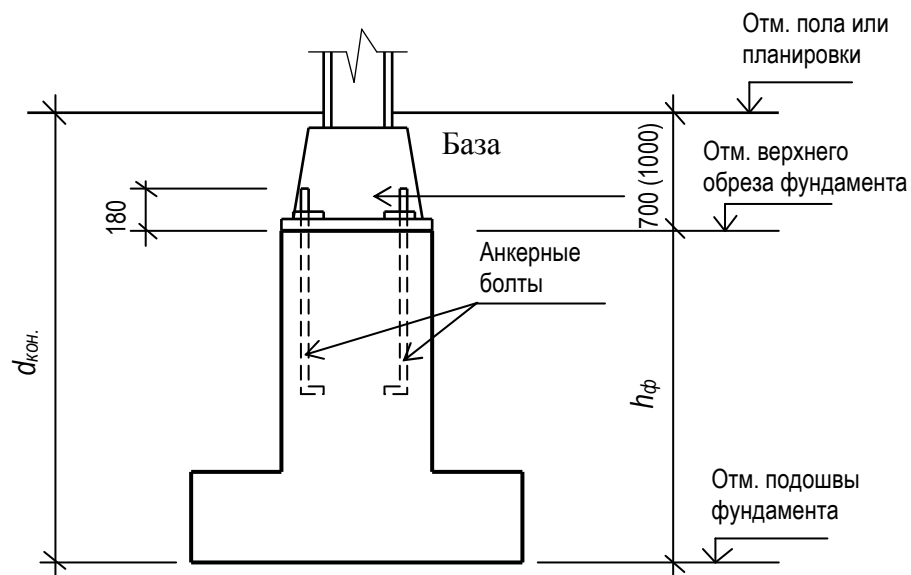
Предварительное конструирование отдельного (столбчатого), монолитного фундамента под металлическую колонну.
